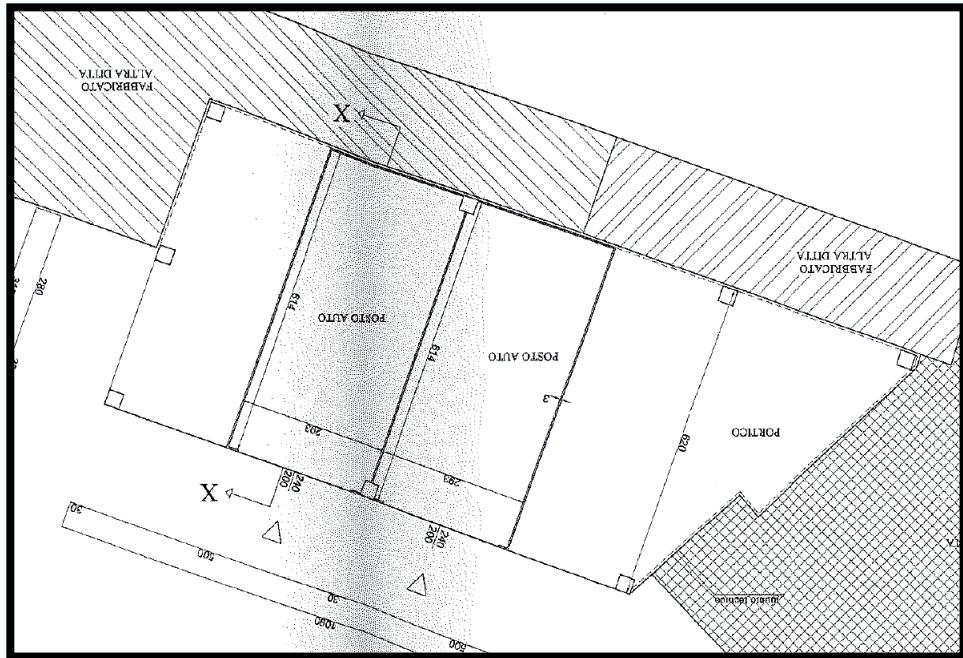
Pianta piano terra allegata alla D.I.A.6740/2009
